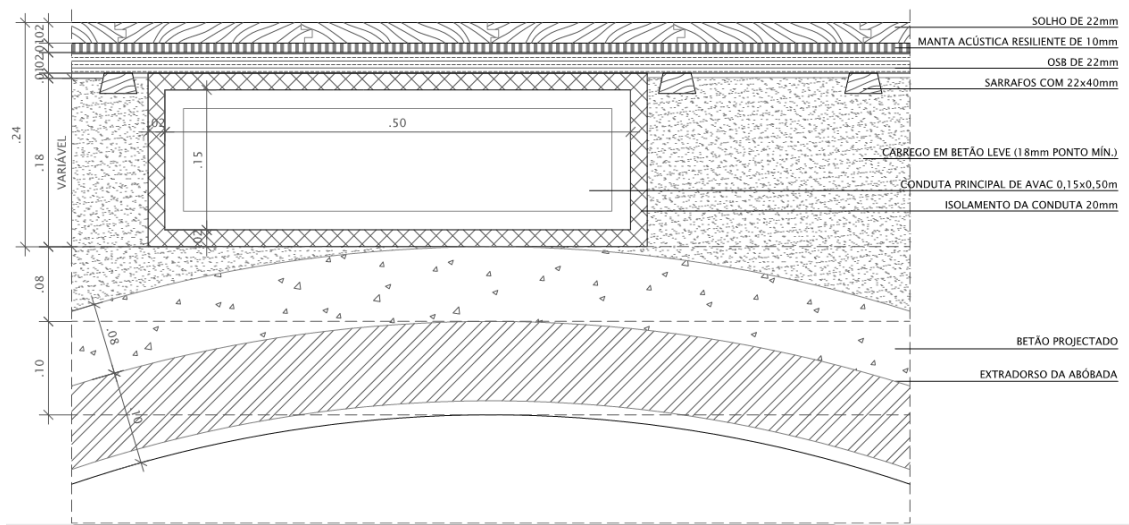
Pormenor do pavimento do piso 1 do edifício B.
